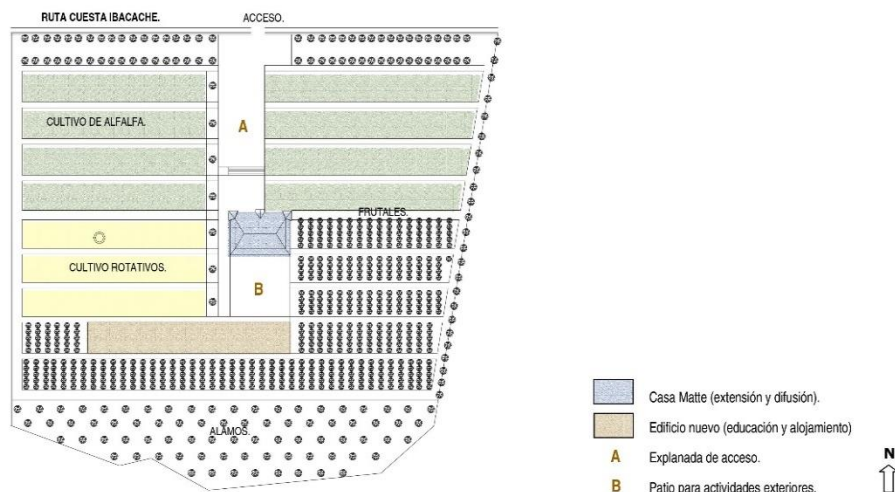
Planta de propuesta arquitectónica, de la casa María Pinto. Melipilla.
